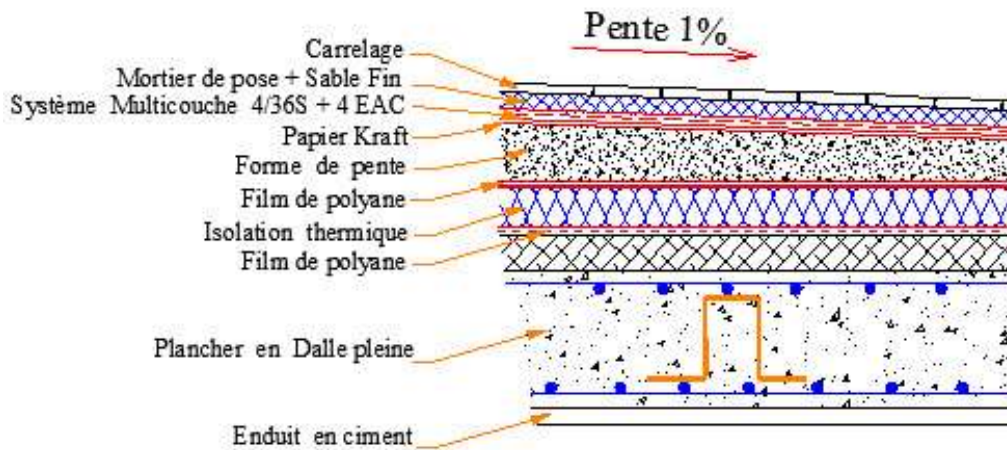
Coupe verticale du plancher terrasse accessible (Dalle pleine)
